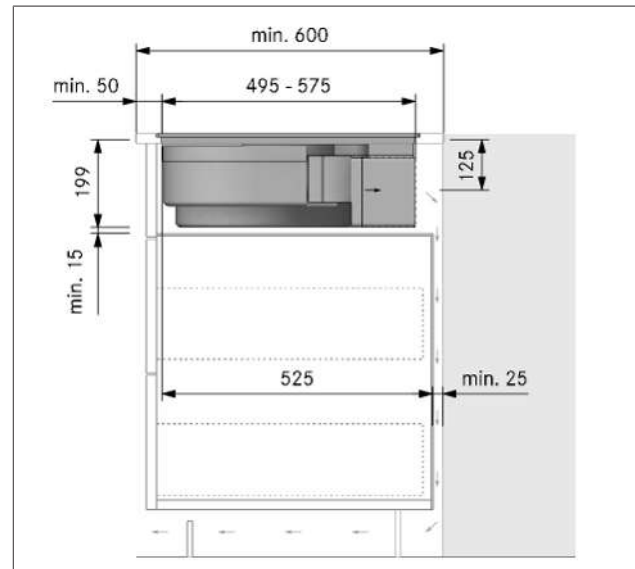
Dimensioni di montaggio con sistema filtrante variante di montaggio B, profondità piano di lavoro 600 mm
